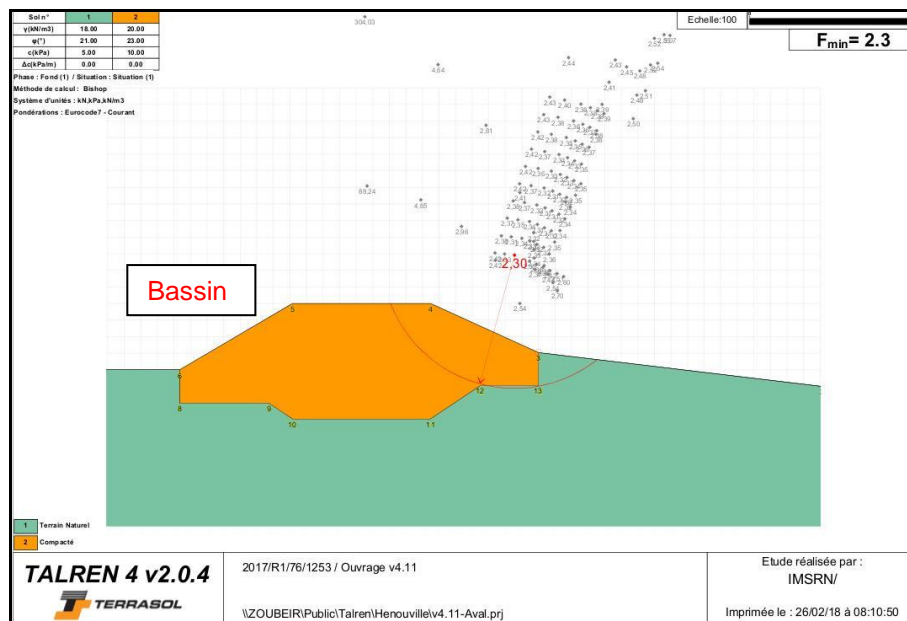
calcul de stabilité du remblai aval en situation fondamentale
